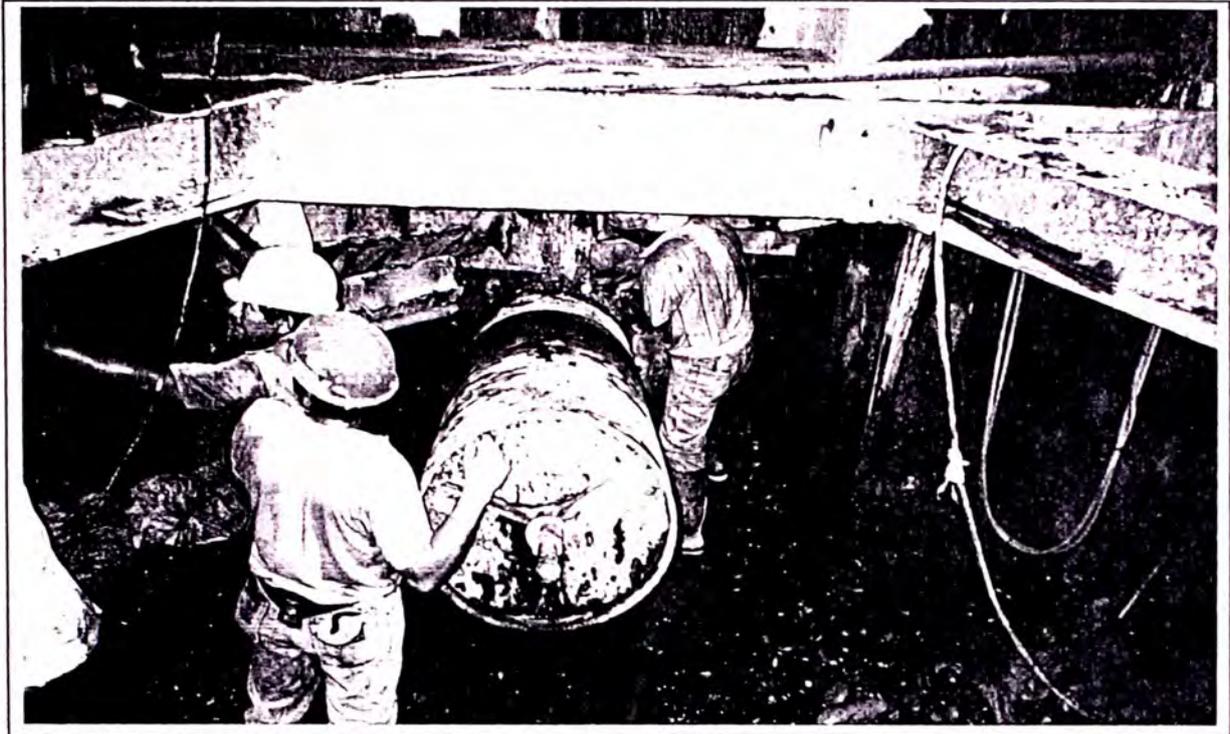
Preparando extracción de la tubería desde el punto deformado.
